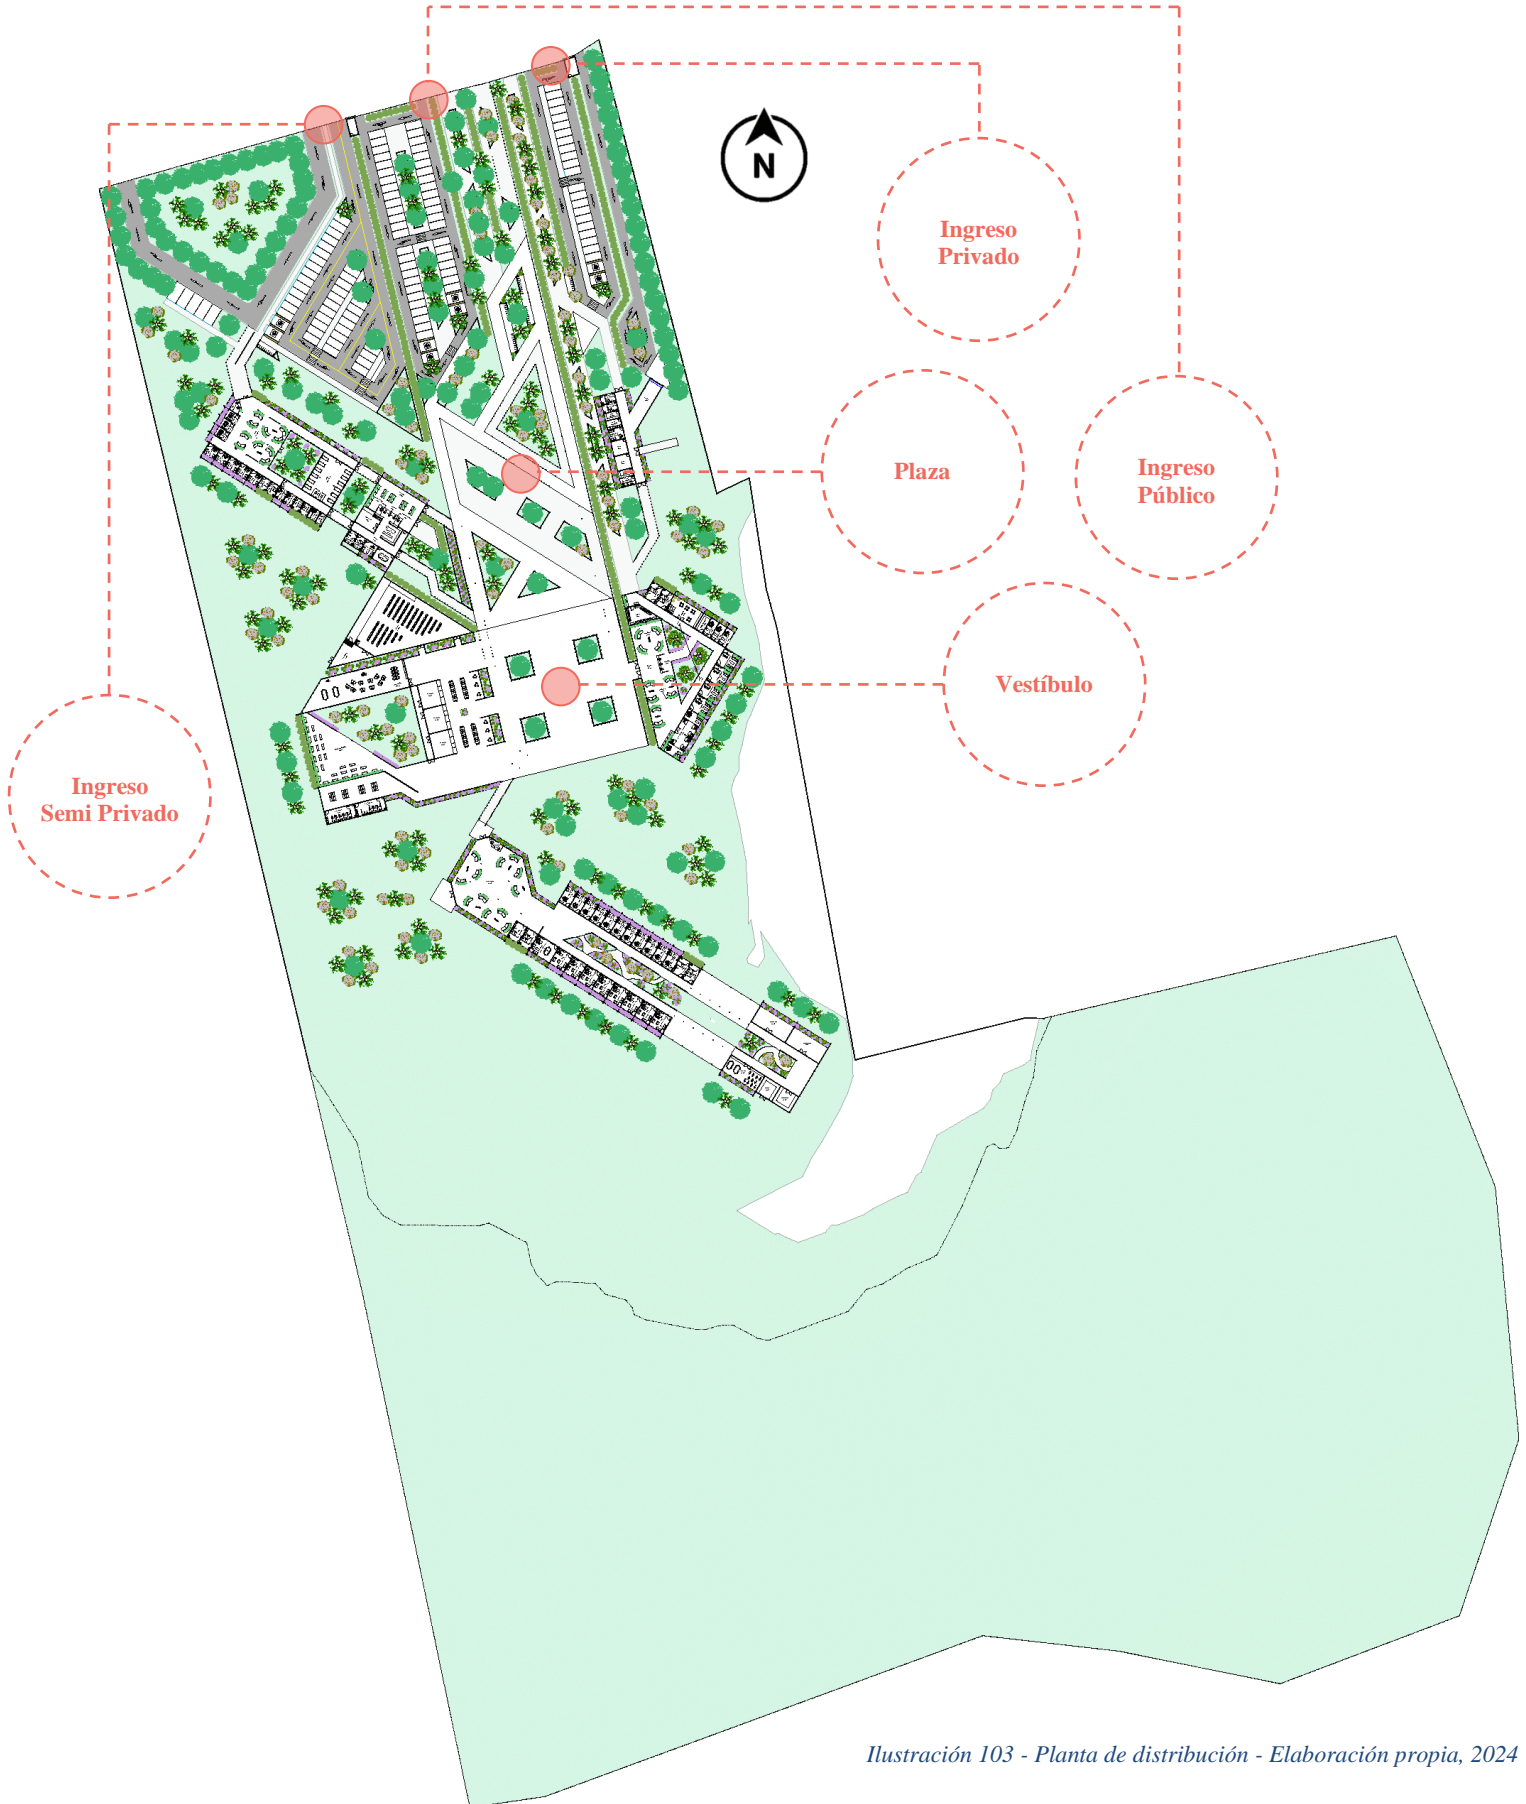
Planta de distribución - Elaboración propia, 2024
